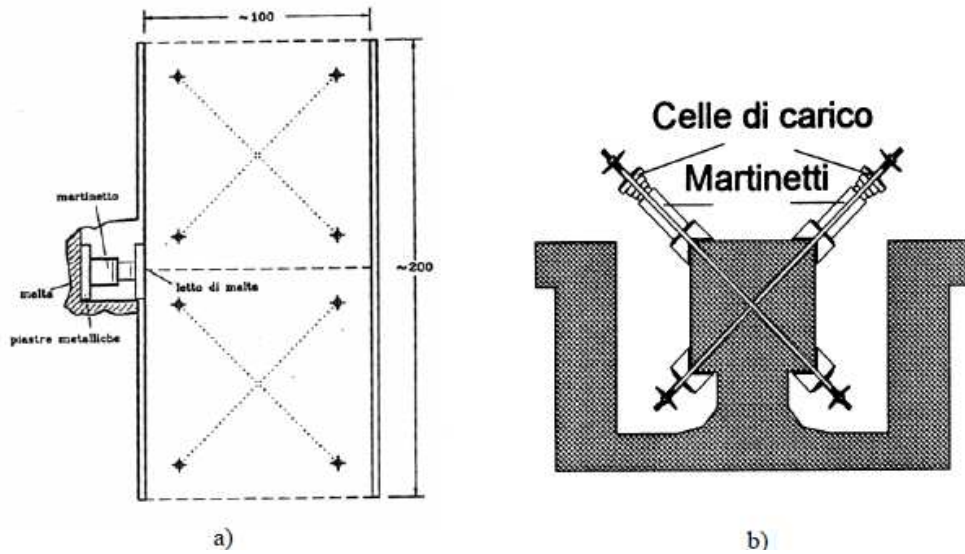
Schemi tipici di prove a taglio diretto in situ
